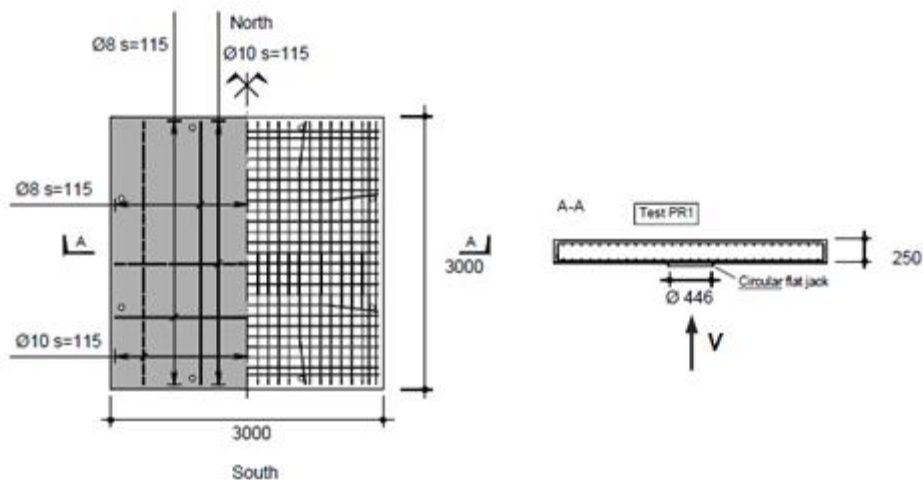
Dimensões da laje e disposição das armaduras (dimensões em mm e m) [2]
